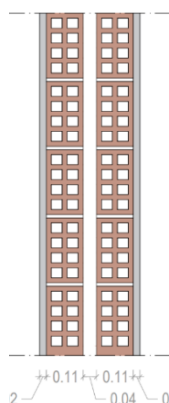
Tipologia de parede exterior adotada para o edifício porticado em betão armado (Adaptado de Dias, 2016)
